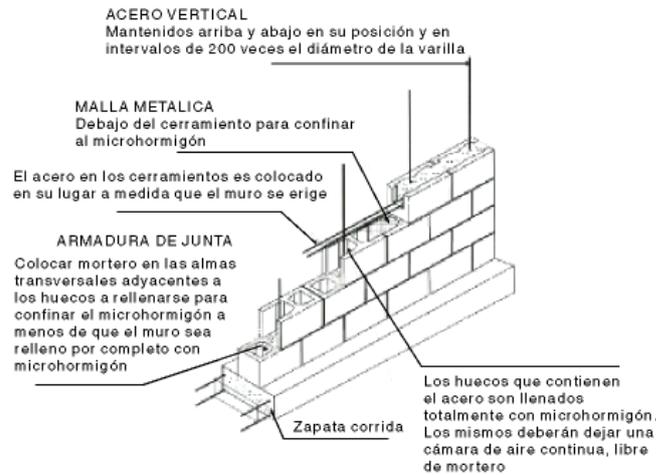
Detalle Mampostería reforzada de Bloques de Hormigón.
